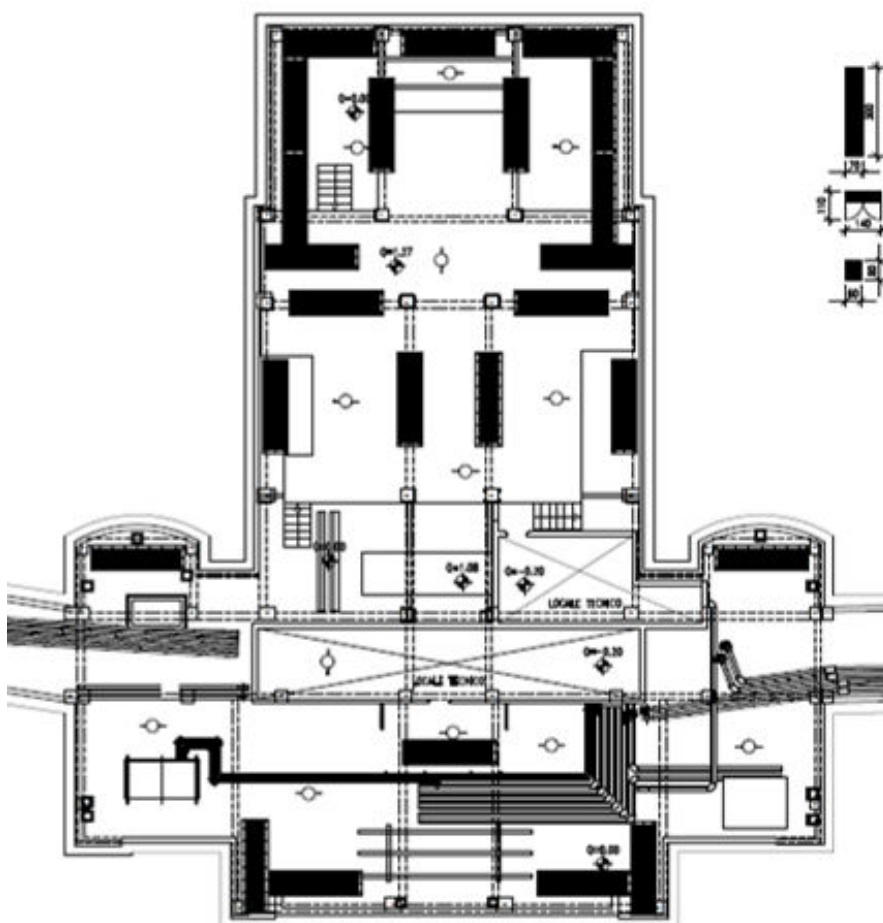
Disposizione planimetrica delle 24 unità macchina del sistema attivo Electro-Pro 20x o similare
